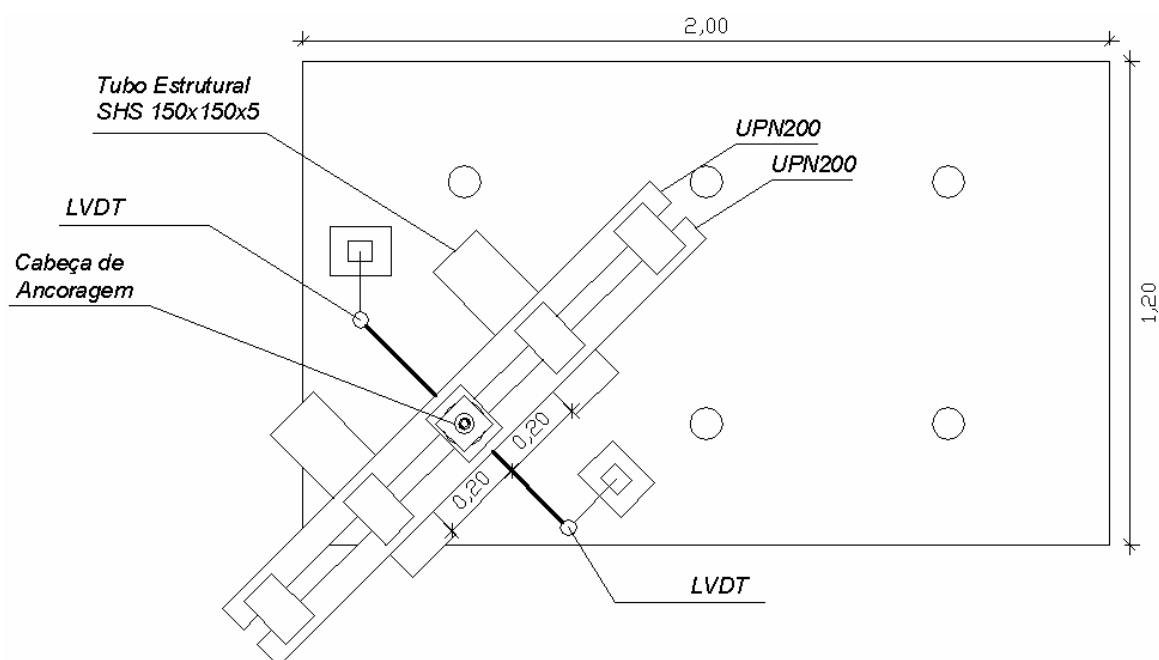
Planta da configuração do ensaio e respectivas dimensões para varões posicionados no canto do maciço de betão
